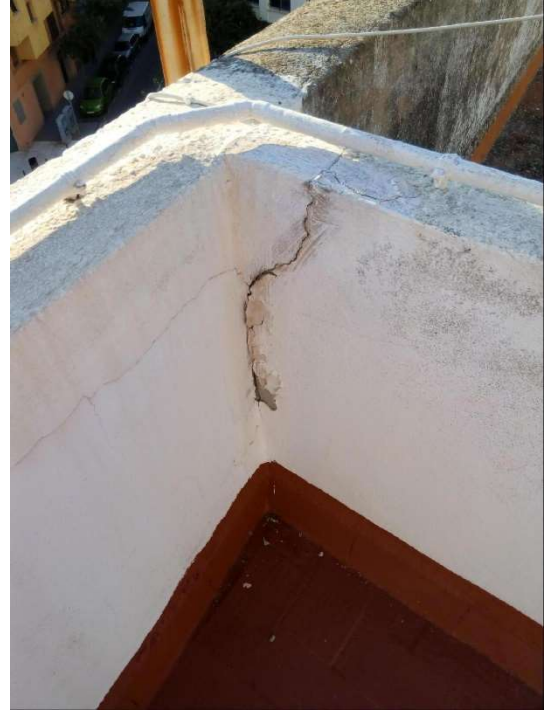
Fisura antepecho cubierta, (Fuente: autor)
